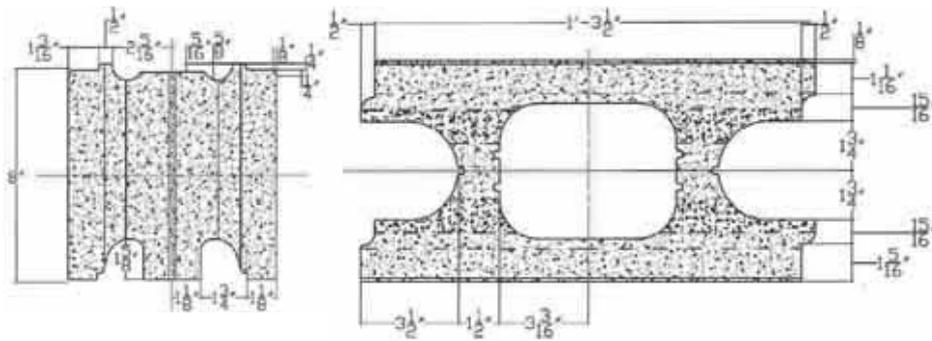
Detalle de la pieza Azar block. Alzado lateral [izquierda] y planta [derecha].
